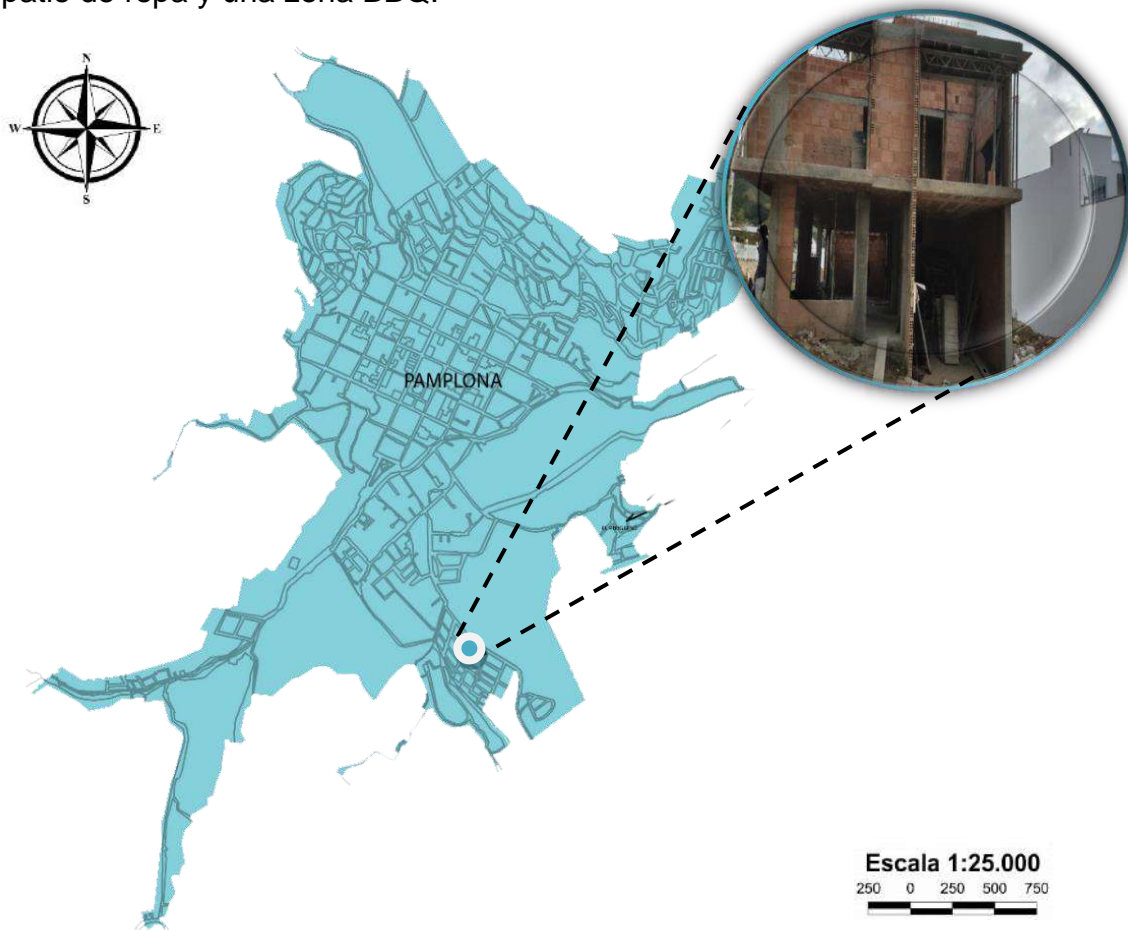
Plano ubicación obra san Sebastián; Fuente: Elaboración propia
